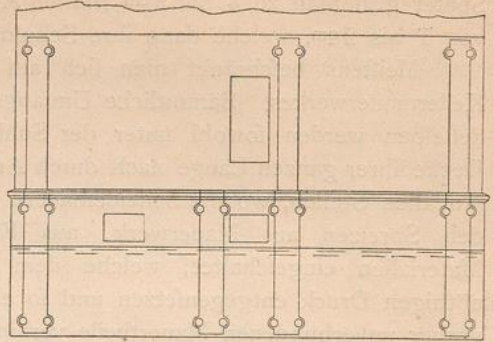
Grundriss des Kellergeschosses.
